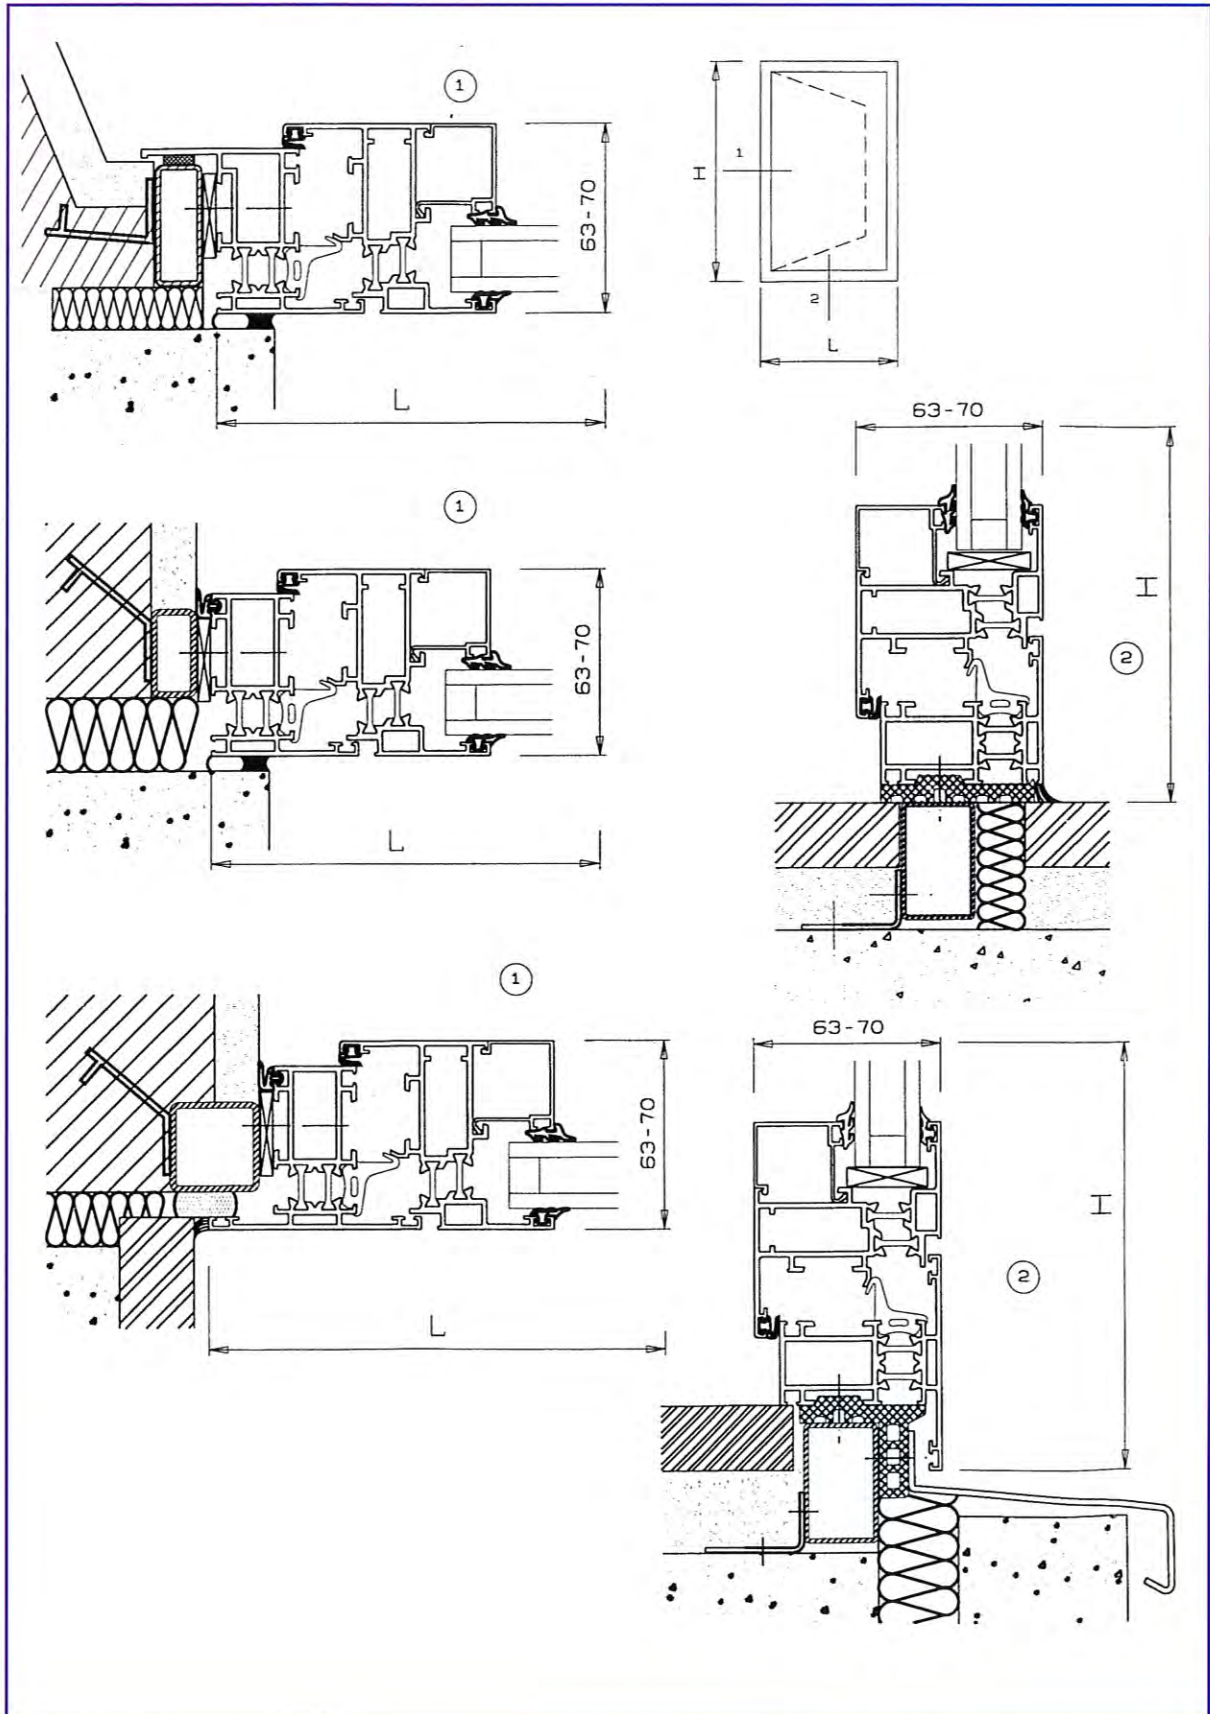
Esempio di un corretto montaggio, con idonei isolamenti, del telaio fisso di un serramento a battente ad un'anta
